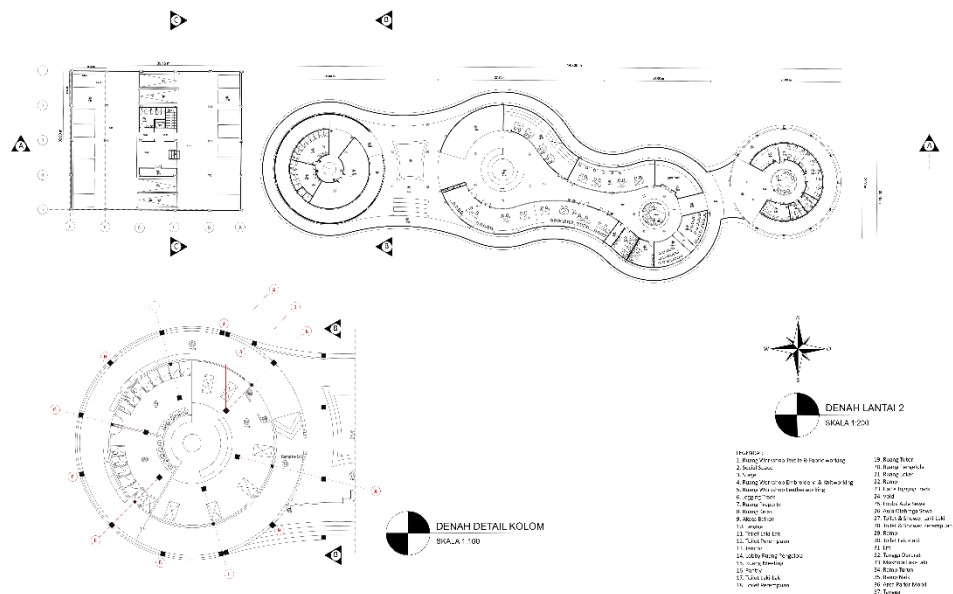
3 Layout Bangunan Arsitektural (Ilustrasi Penulis)
